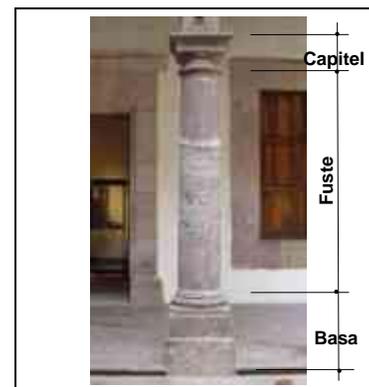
Columna primer patio planta baja, casa de Isidro Huarte.
